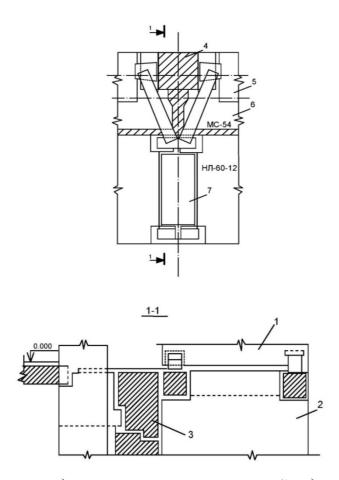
Наружная стена дома, примыкание приставной лоджии к колоннам каркаса: 1,2,7 – стенки лоджии; 3,6 – стеновая ленточная панель; 4 – колонна; 5 – ригель
